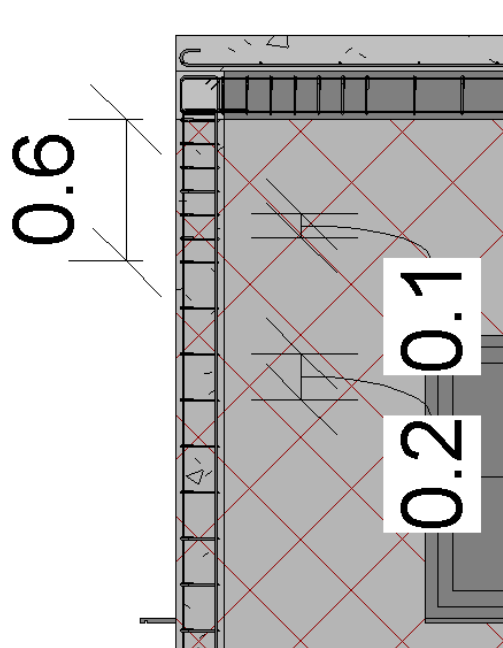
Vista de diseño de los anclajes de columnas de encadenado
